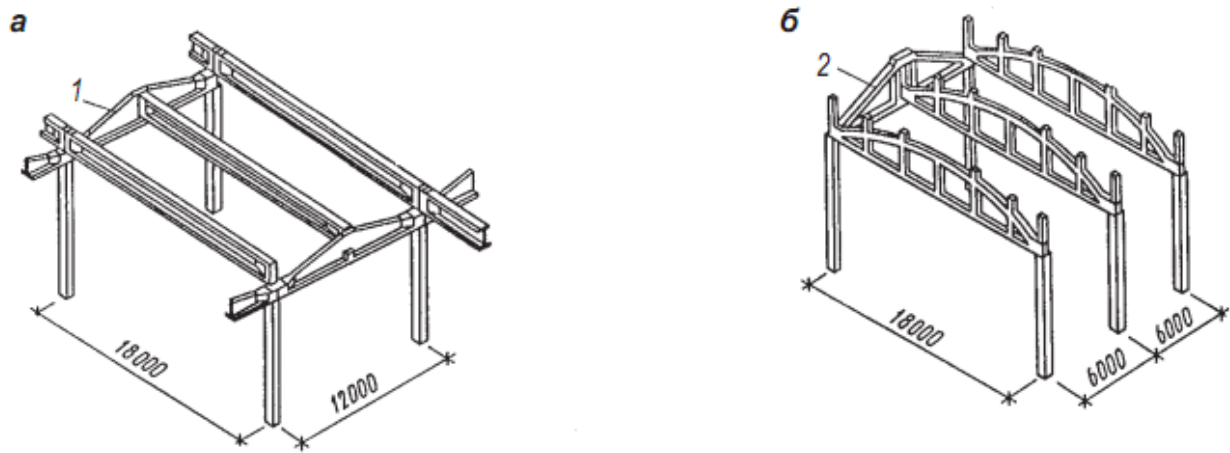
Залізобетонні підкроквяні балки і ферми: а, б – конструктивні схеми; 1 – підкроквяна балка; 2 – підкроквяна ферма
